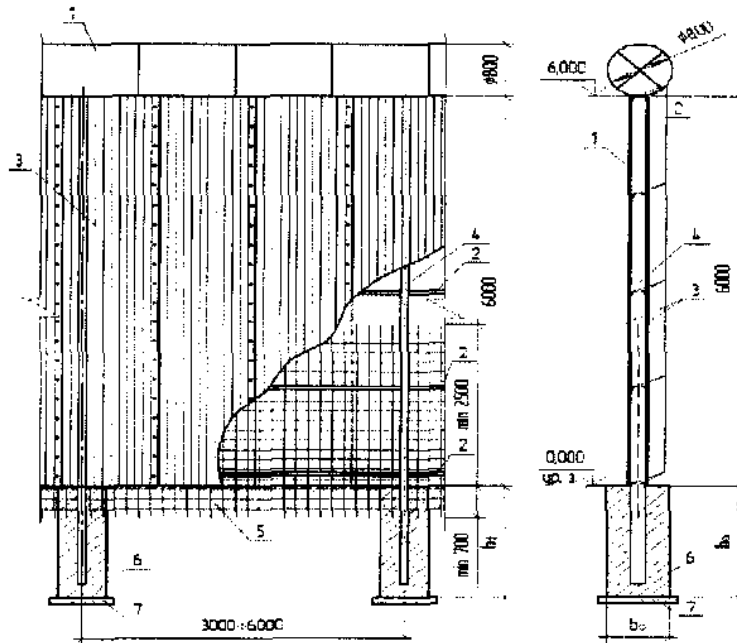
а. Основное ограждение из монолитного железобетона
